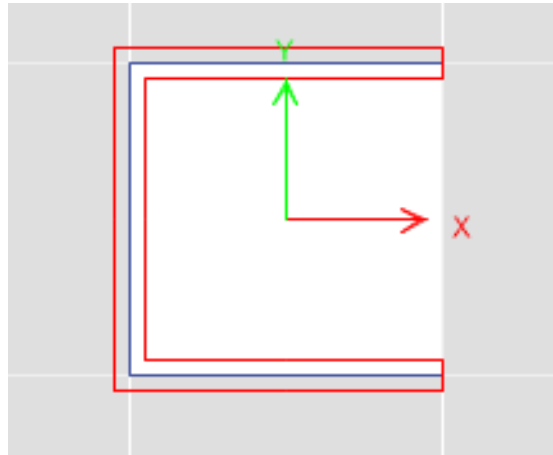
« Vue en plan de noyau 2.95*2.95 cm² »
